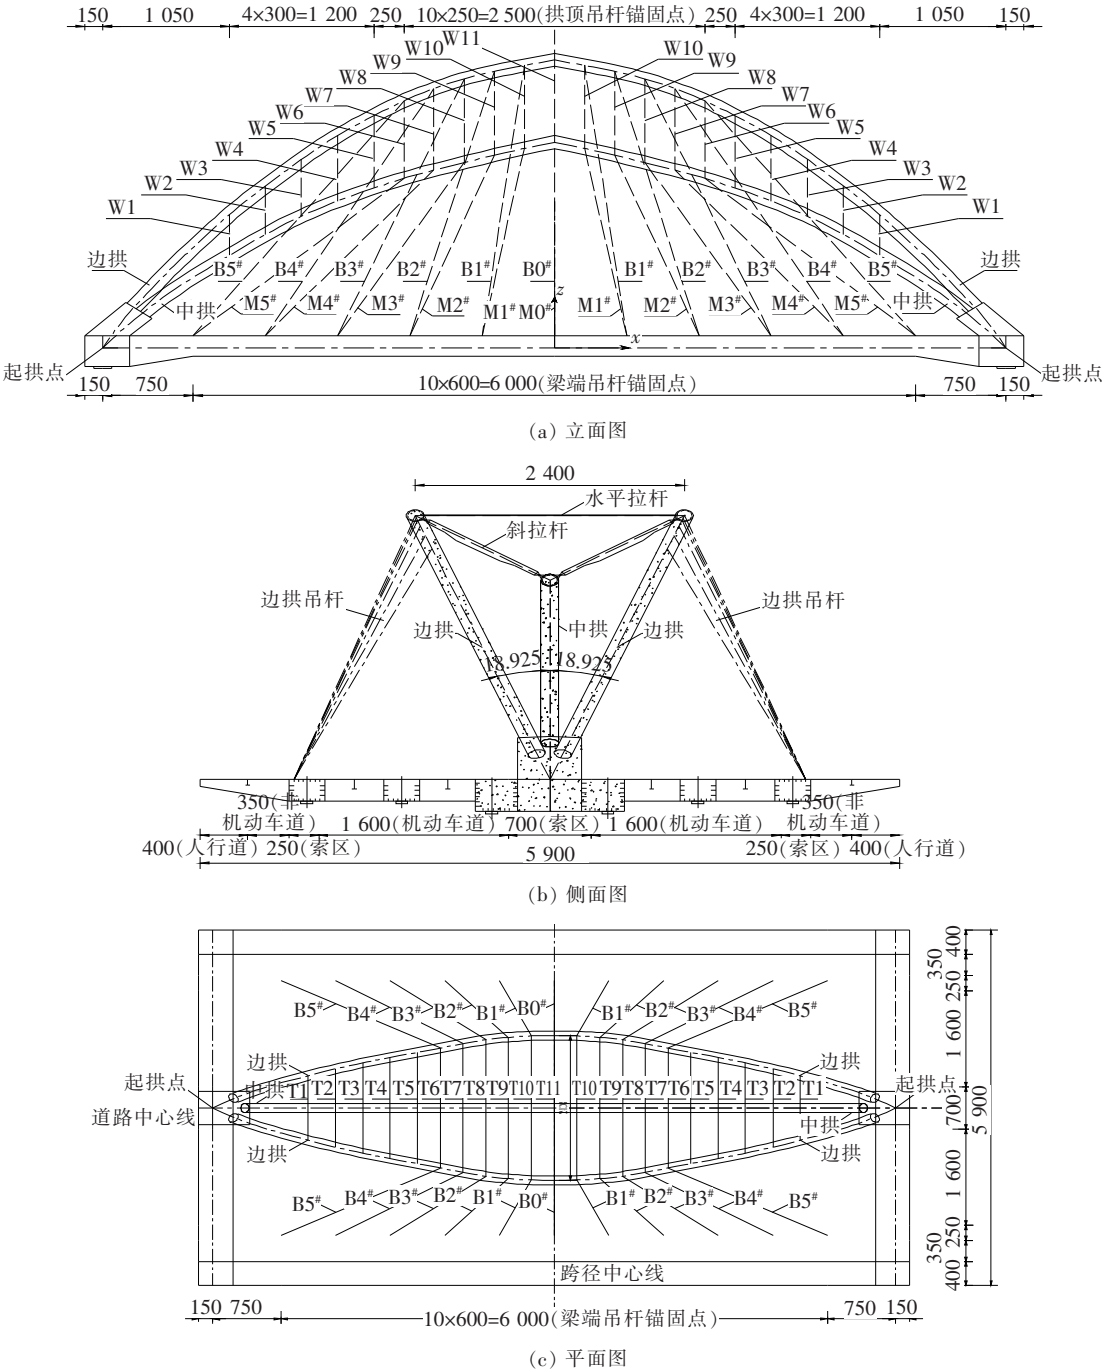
多拱肋宽幅异形钢管混凝土拱桥布置图(单位:cm)
